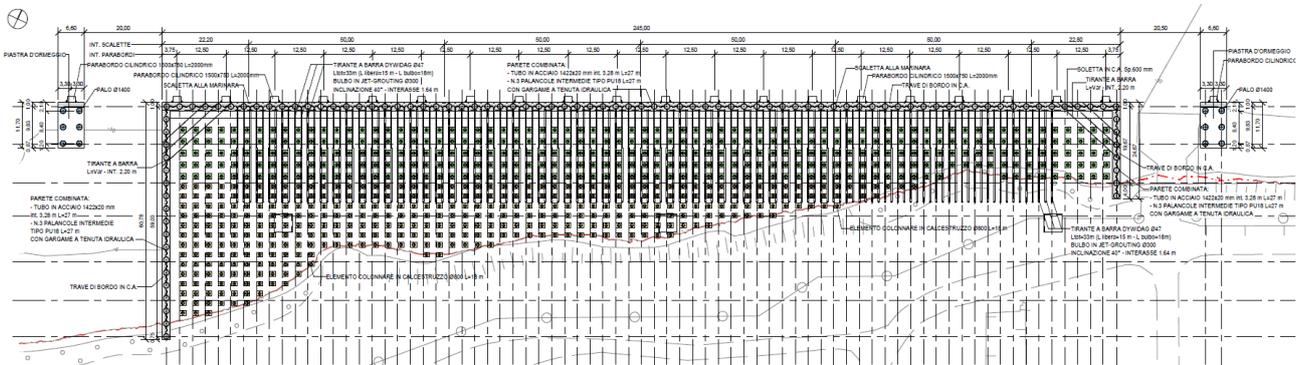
Planimetria di progetto (Lotto 1a).
